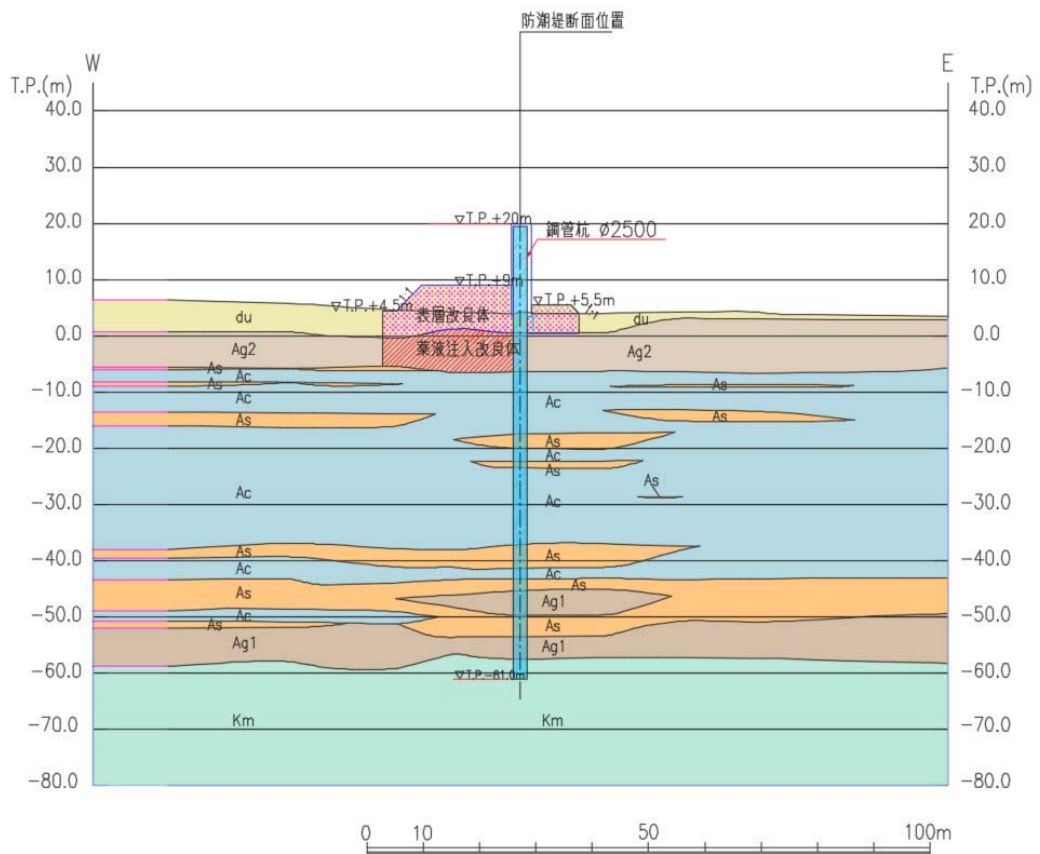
地震応答解析対象断面図 (断面③)
